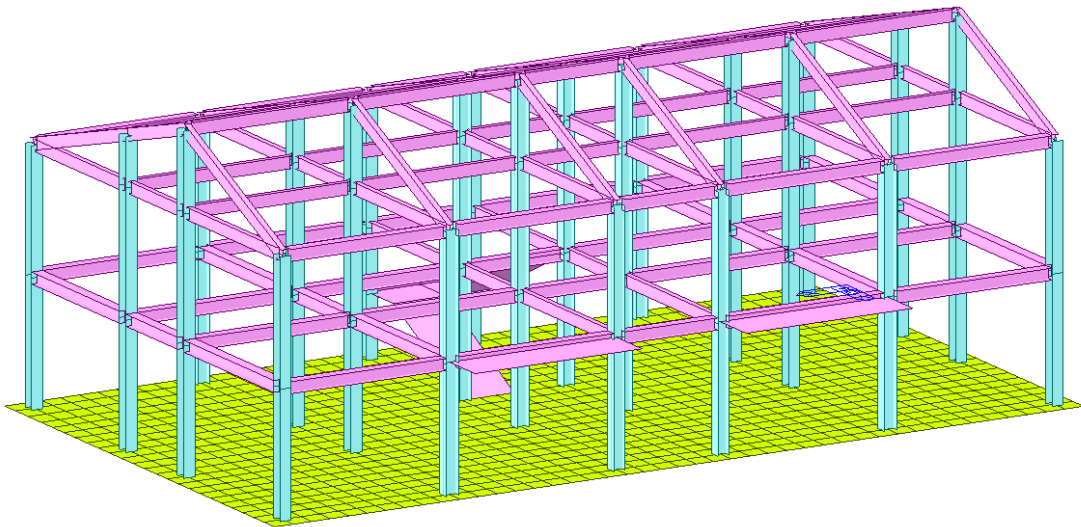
Modello FEM edificio a due piani in acciaio con platea di fondazione - Vista assometrica 2.
